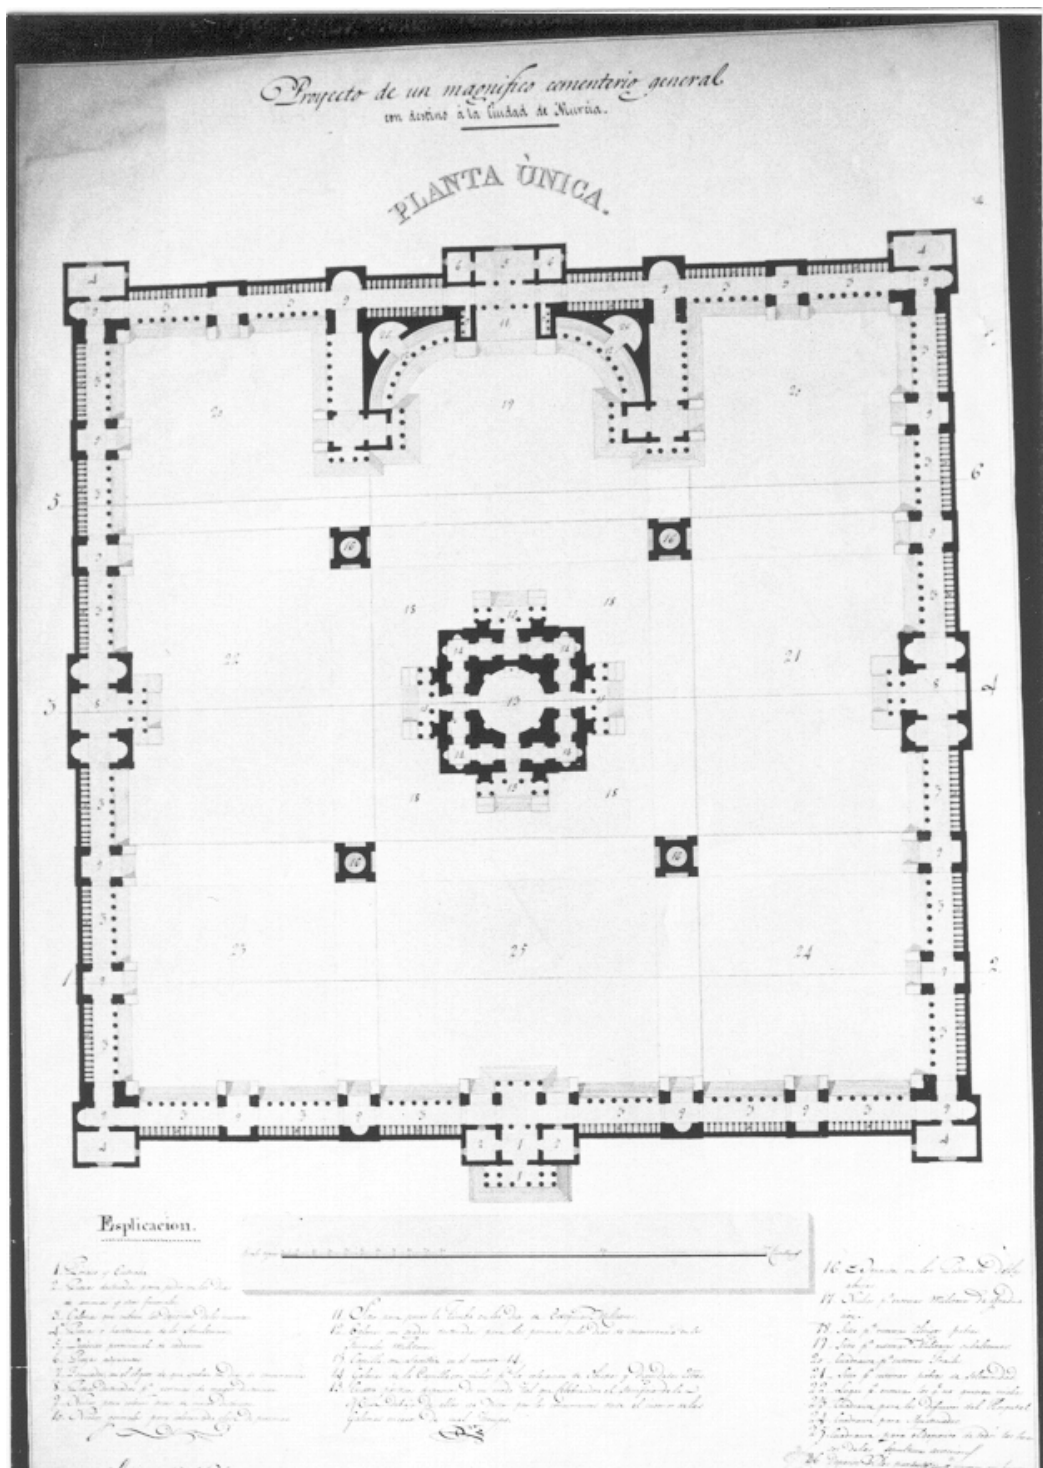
Planta de cementerio para Murcia de Francisco Bolarín Gómez
